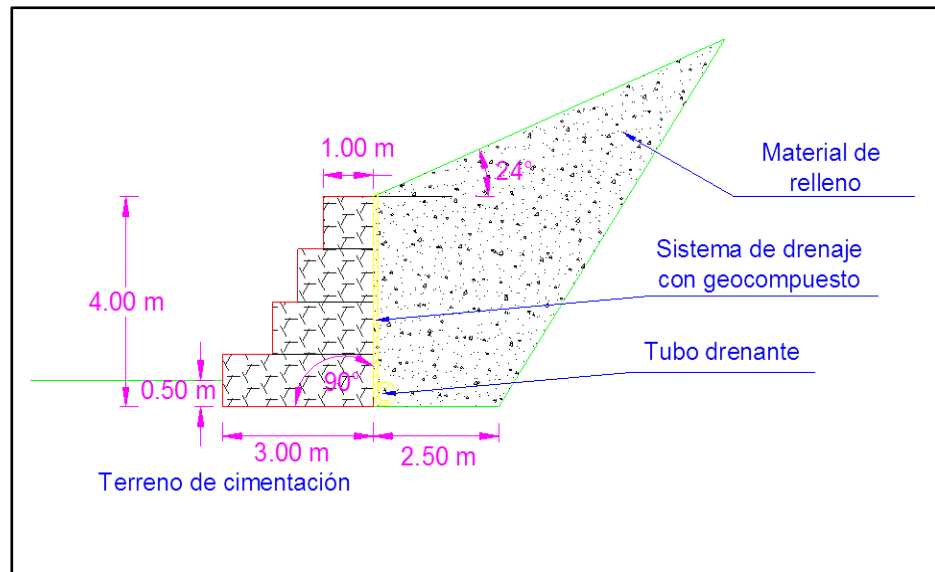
Detalle del muro de gaviones colocado al pie del talud 1.
